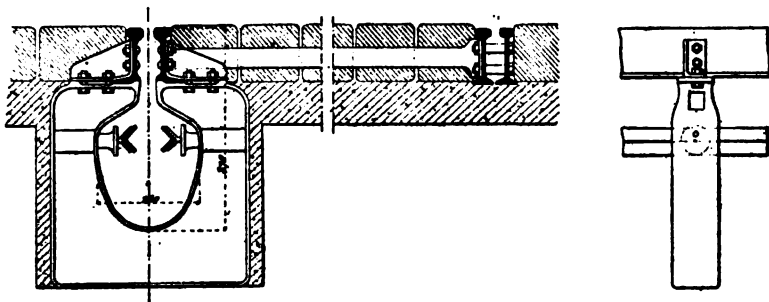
Coupe du caniveau souterrain, système Siemens et Halske.
